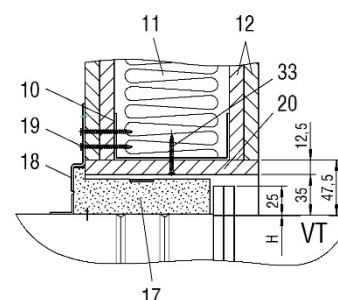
montaggio a secco con telaio a incasso ER-P1 (sezione) in parete divisoria leggera (F90)
